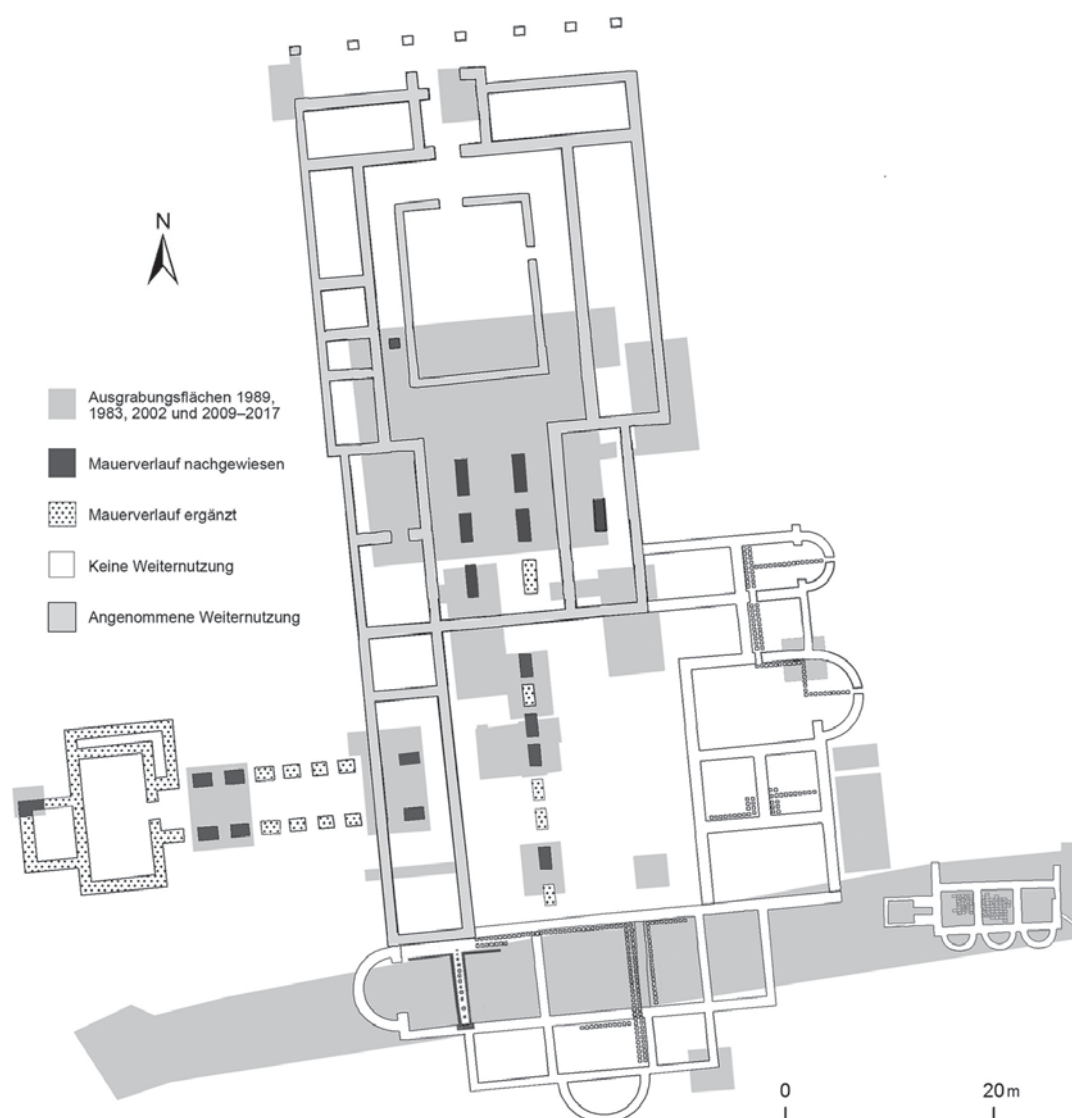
Rekonstruierter Grundriss der Bauphase C des Gebäudes 25 (Grafik: Autoren)
